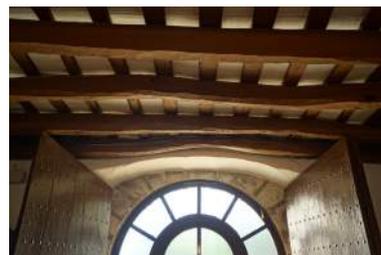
Can Mora. Cobertura do tramo central com vigamento de madeira.
